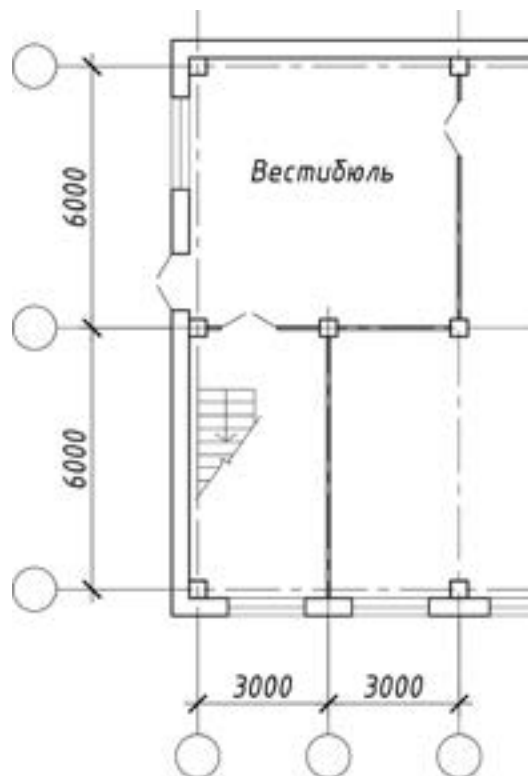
Фрагмент план этажа здания системы 1.020-1/87 (ИИ 04)
